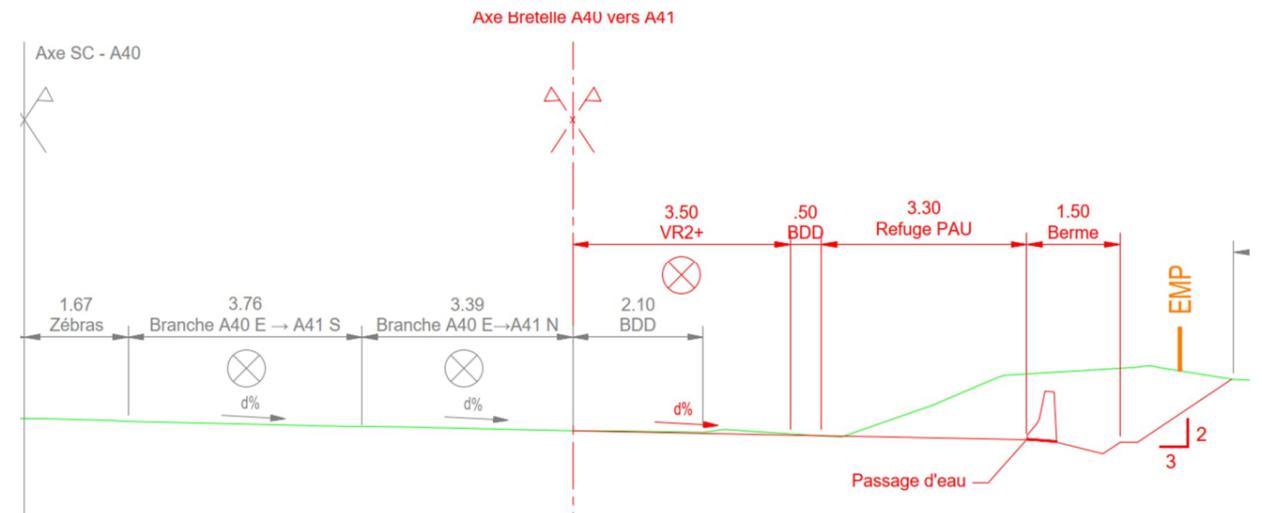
Profil en travers type de la VR2+ sur la bretelle A40 -> A41 – PT C
